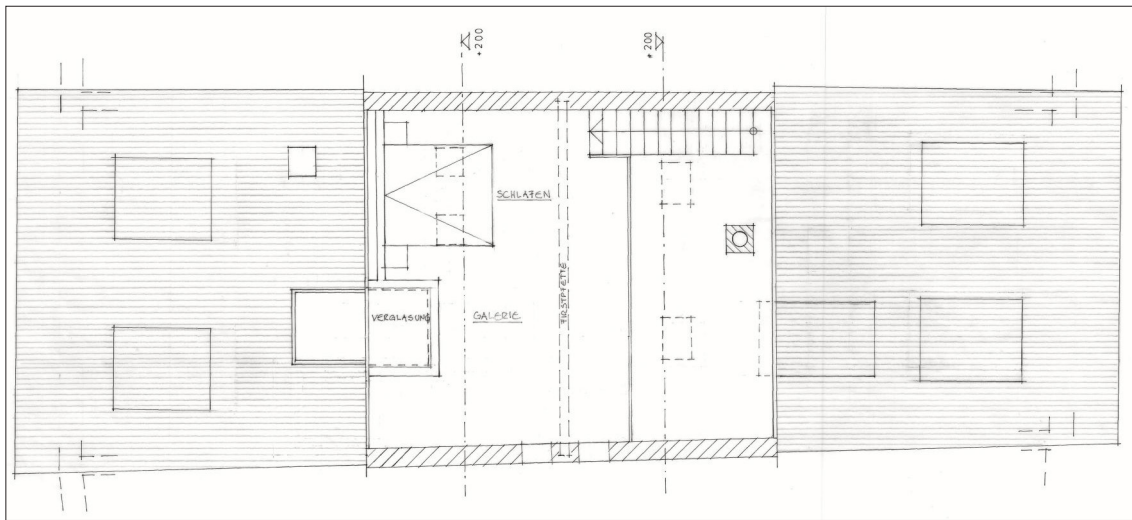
Haus Vorgasse 44 in Neunkirch. Grundriss 5. Obergeschoss. Zeichnung: Christina Waldvogel, Beringen.
